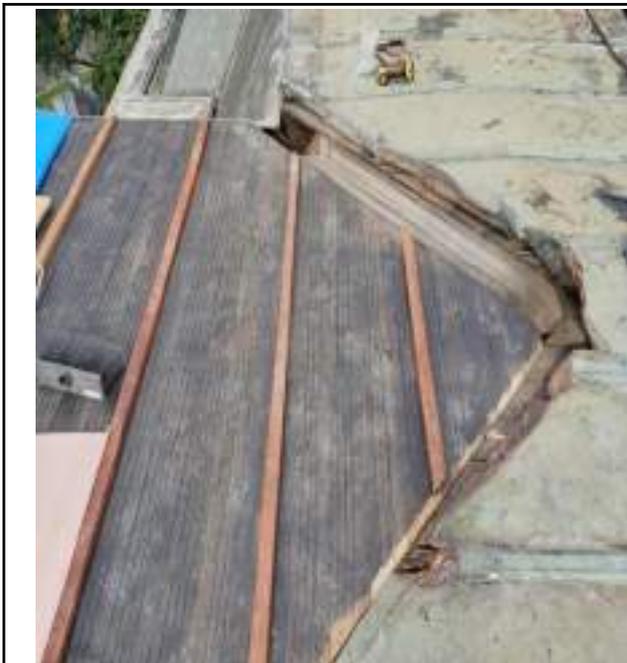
Atividade de conservação da cobertura, instalação das telhas em cobre.
